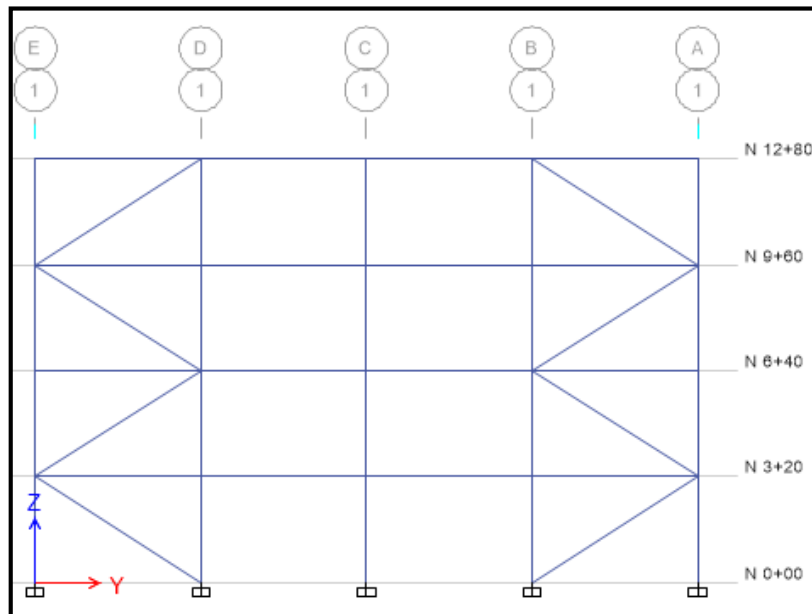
Elevación vista en el plano Y-Z con pórticos arriostrados
